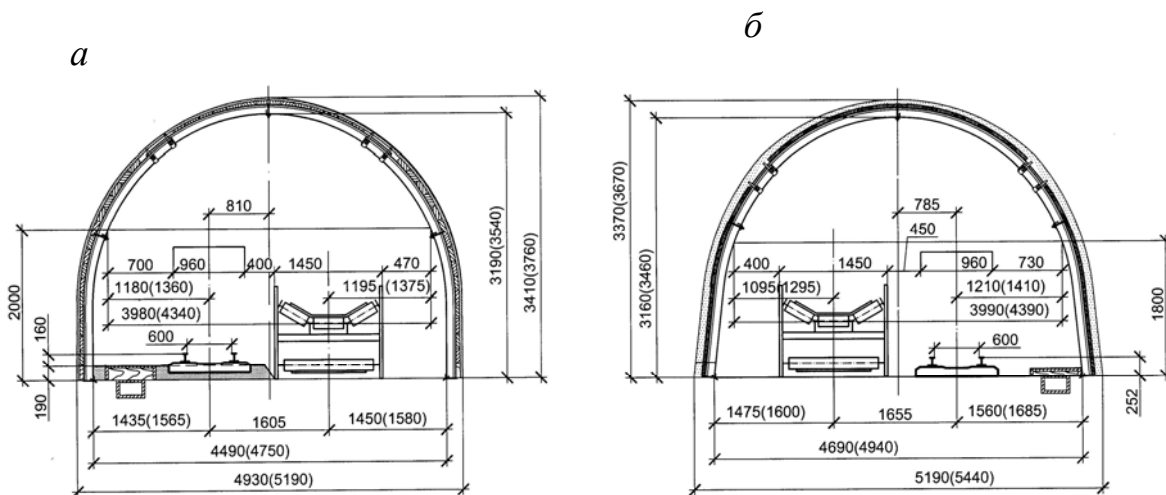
Схеми конструкцій кріплення: – типової; – шатрової
